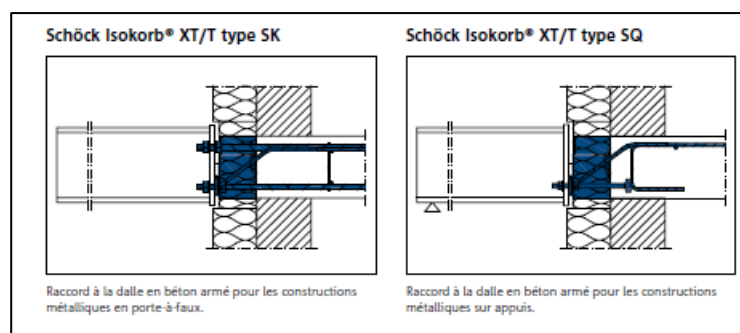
Exemples de constructions utilisant le rupteur de pont thermique en isolation extérieure Schöck Isokorb
